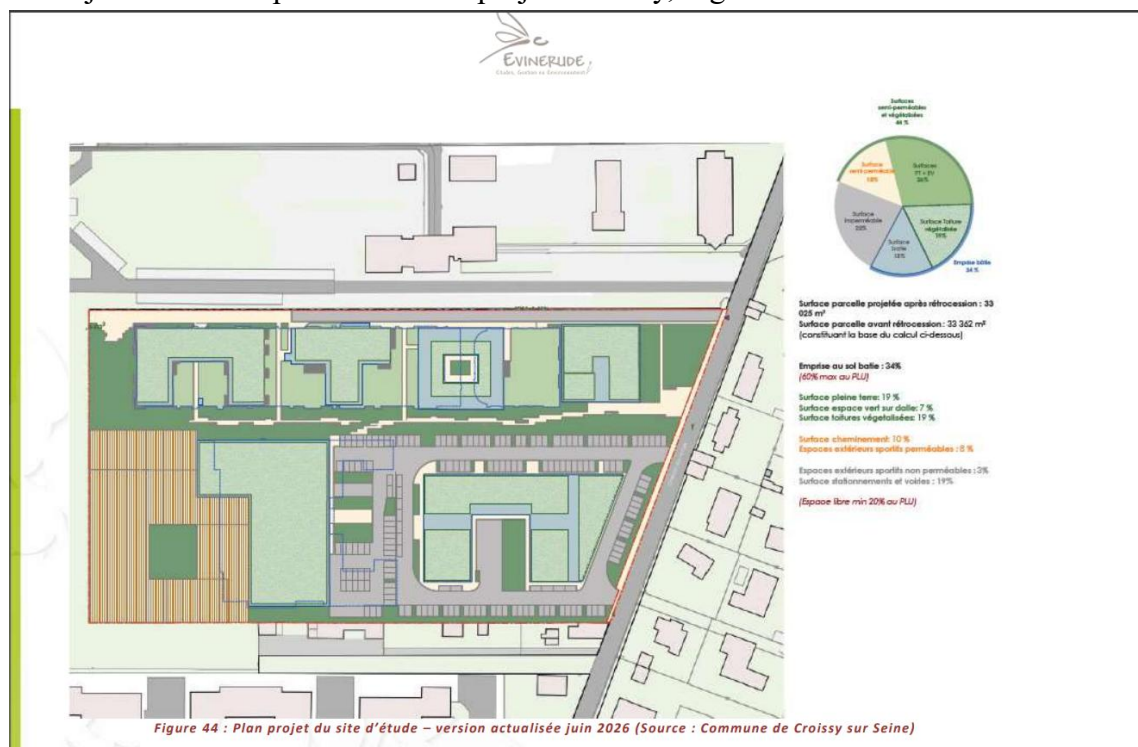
Plan projet du site d'étude – version actualisée juin 2026 (Source : Commune de Croissy sur Seine)
